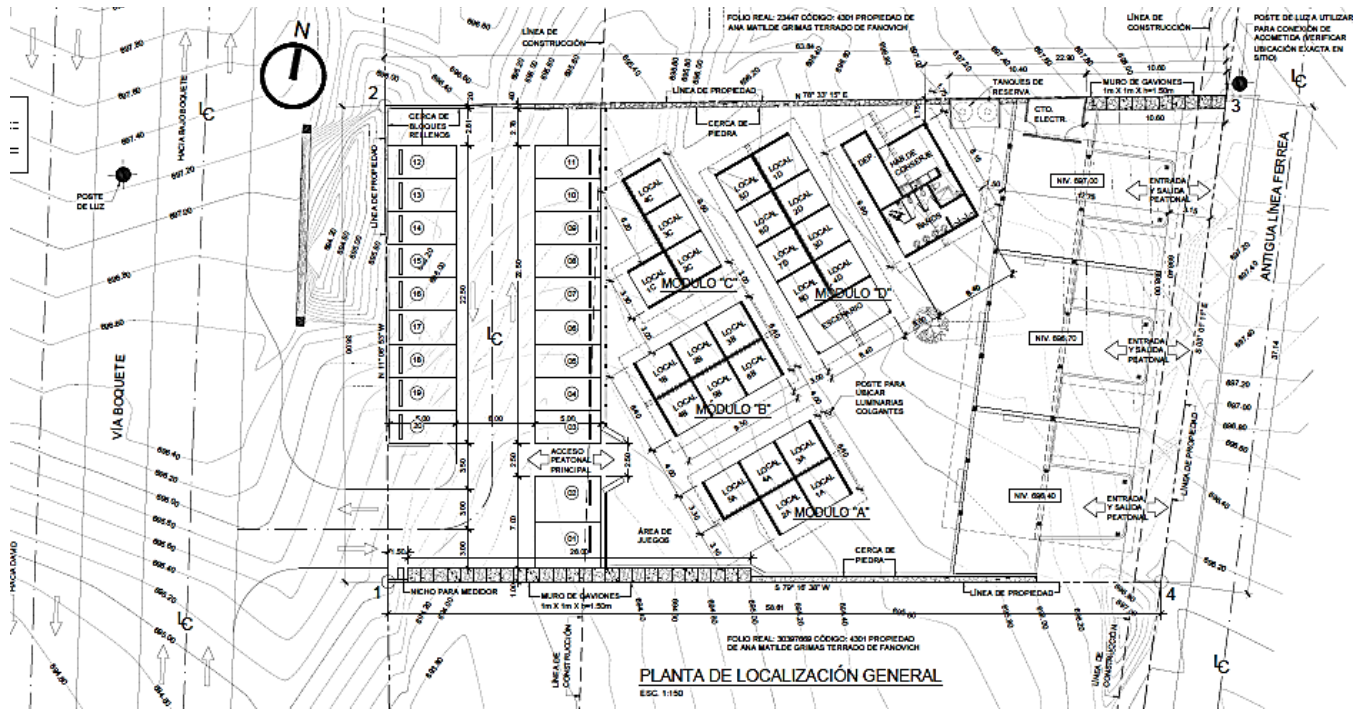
Vista general de la planta arquitectónica proyecto Plaza Comercial “La Parada”.
